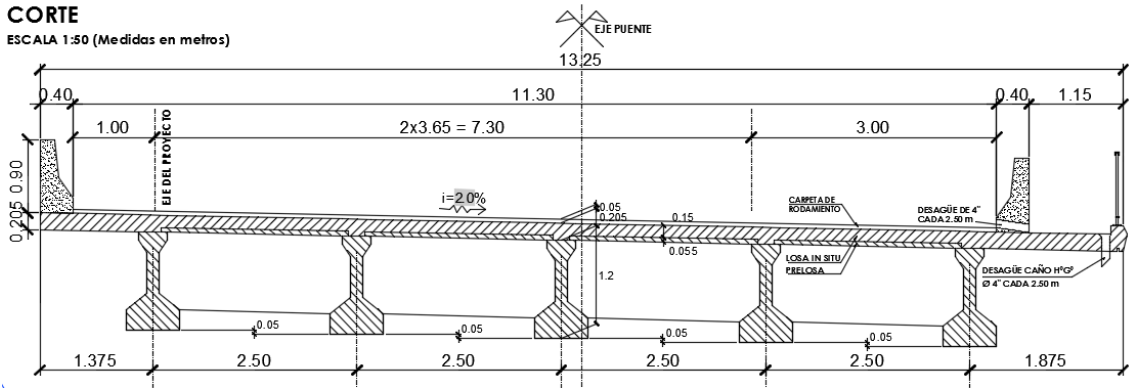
Sección transversal superestructura del Puente típico de la clase VH-SATM.
